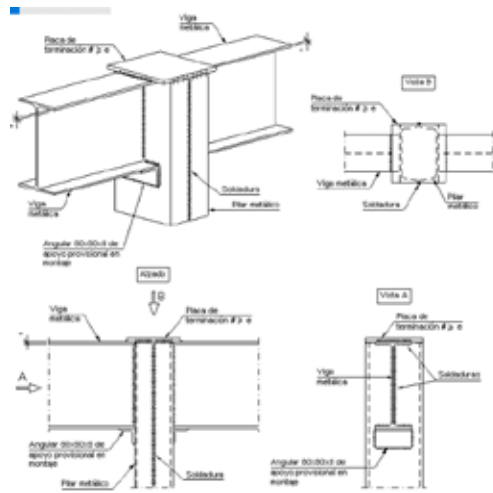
Soldaduras Vigas IPE y Columnas 2UPN
